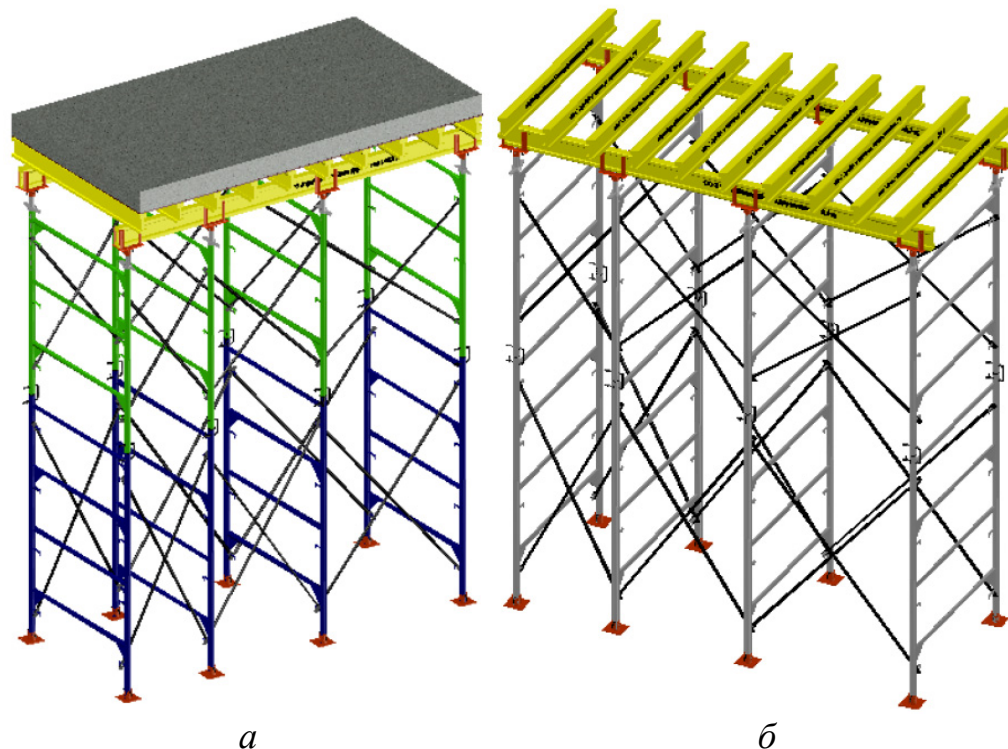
Рамная опалубка: *а* – стальной каркас; *б* – алюминиевый каркас
